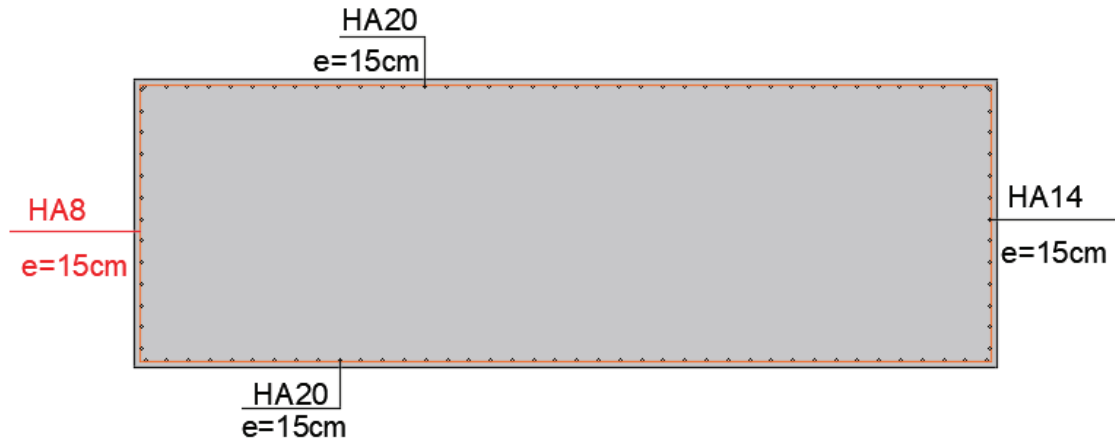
Ferrailage de chevêtre (coupe transversale).
